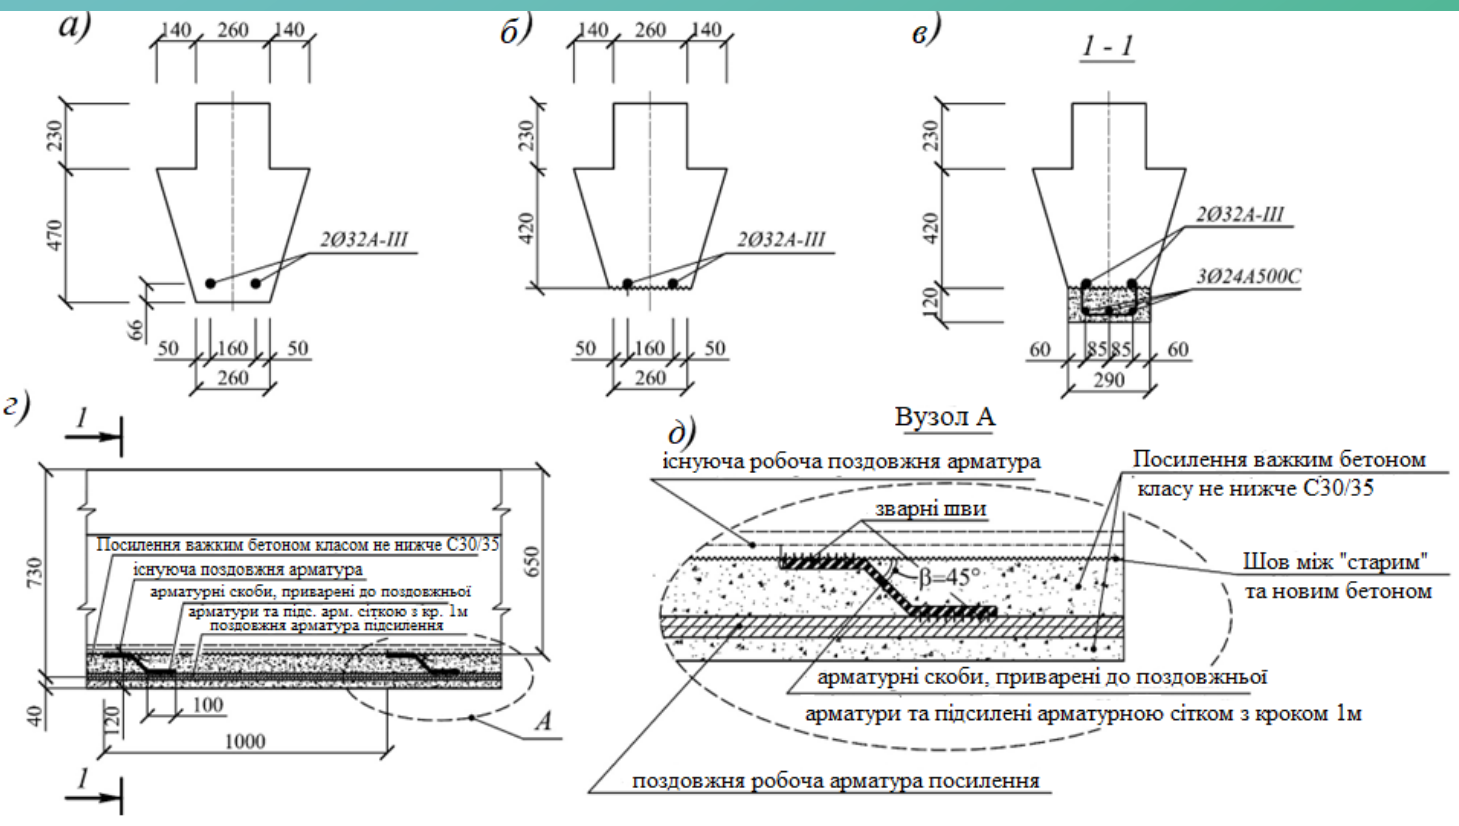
Варіант 1 - Збільшення поперечного перерізу ригелю шляхом влаштування залізобетонного нарощення у розтягнутій зоні із відновленням захисного шару бетону:
